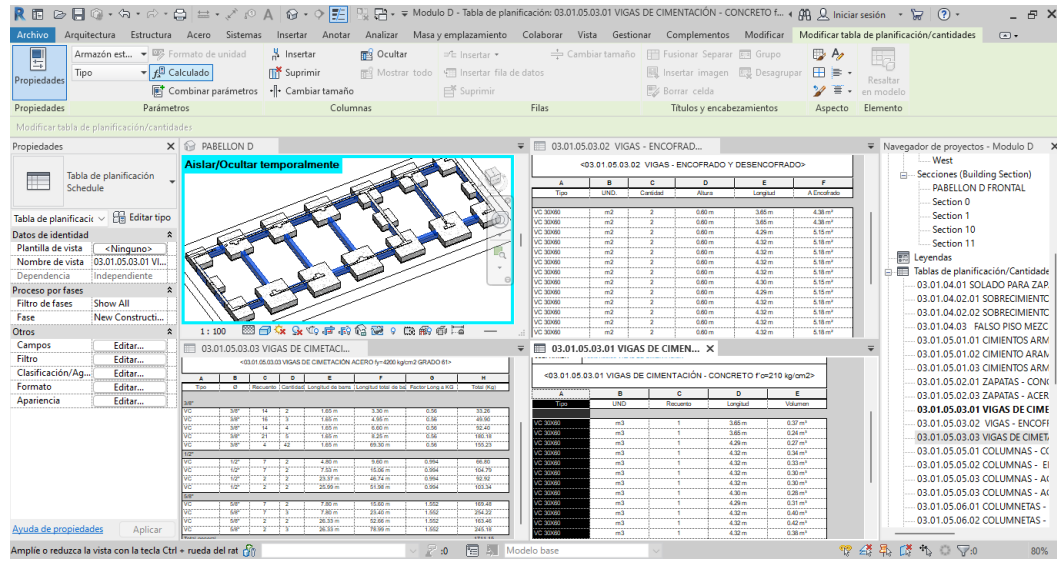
Modelado y metrados de la partida Viga de cimentación Modulo D.
